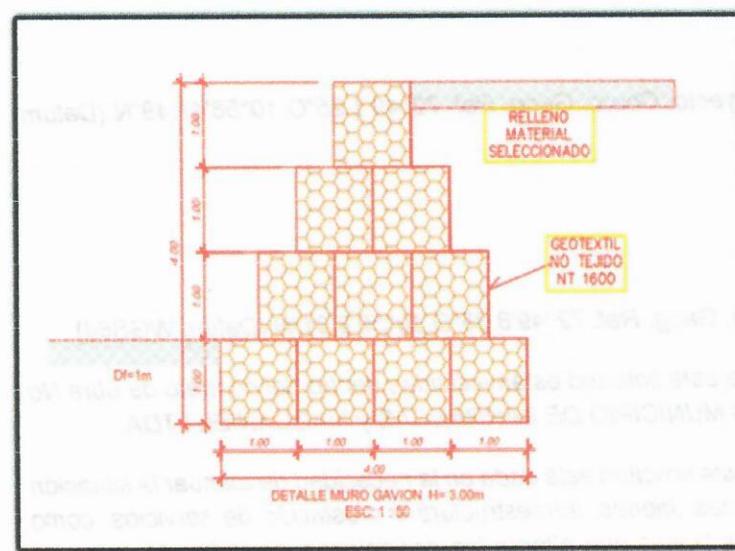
Detalles muro en Gavión desde Km 0+000 a Km 1 +250 en ambas margenes.
